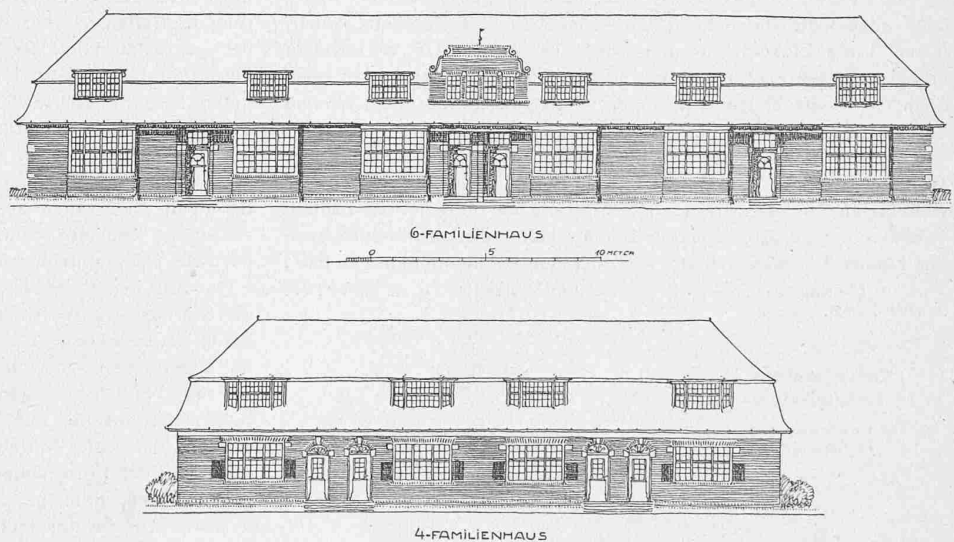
und 7. Fassaden. — Masstab 1:300.
